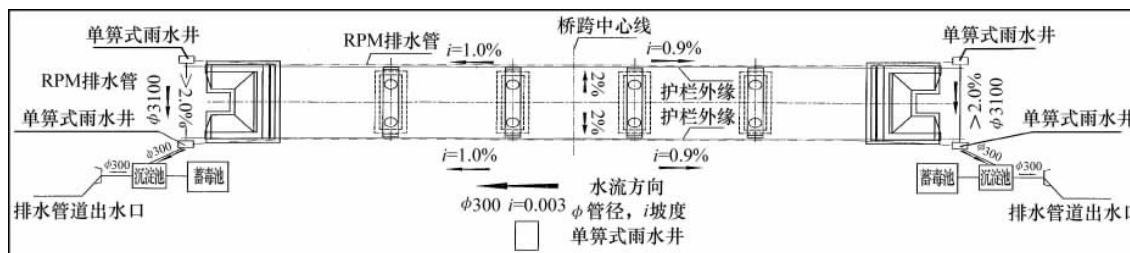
桥梁排水系统改造平面布置示意(排水管管径单位: mm)
